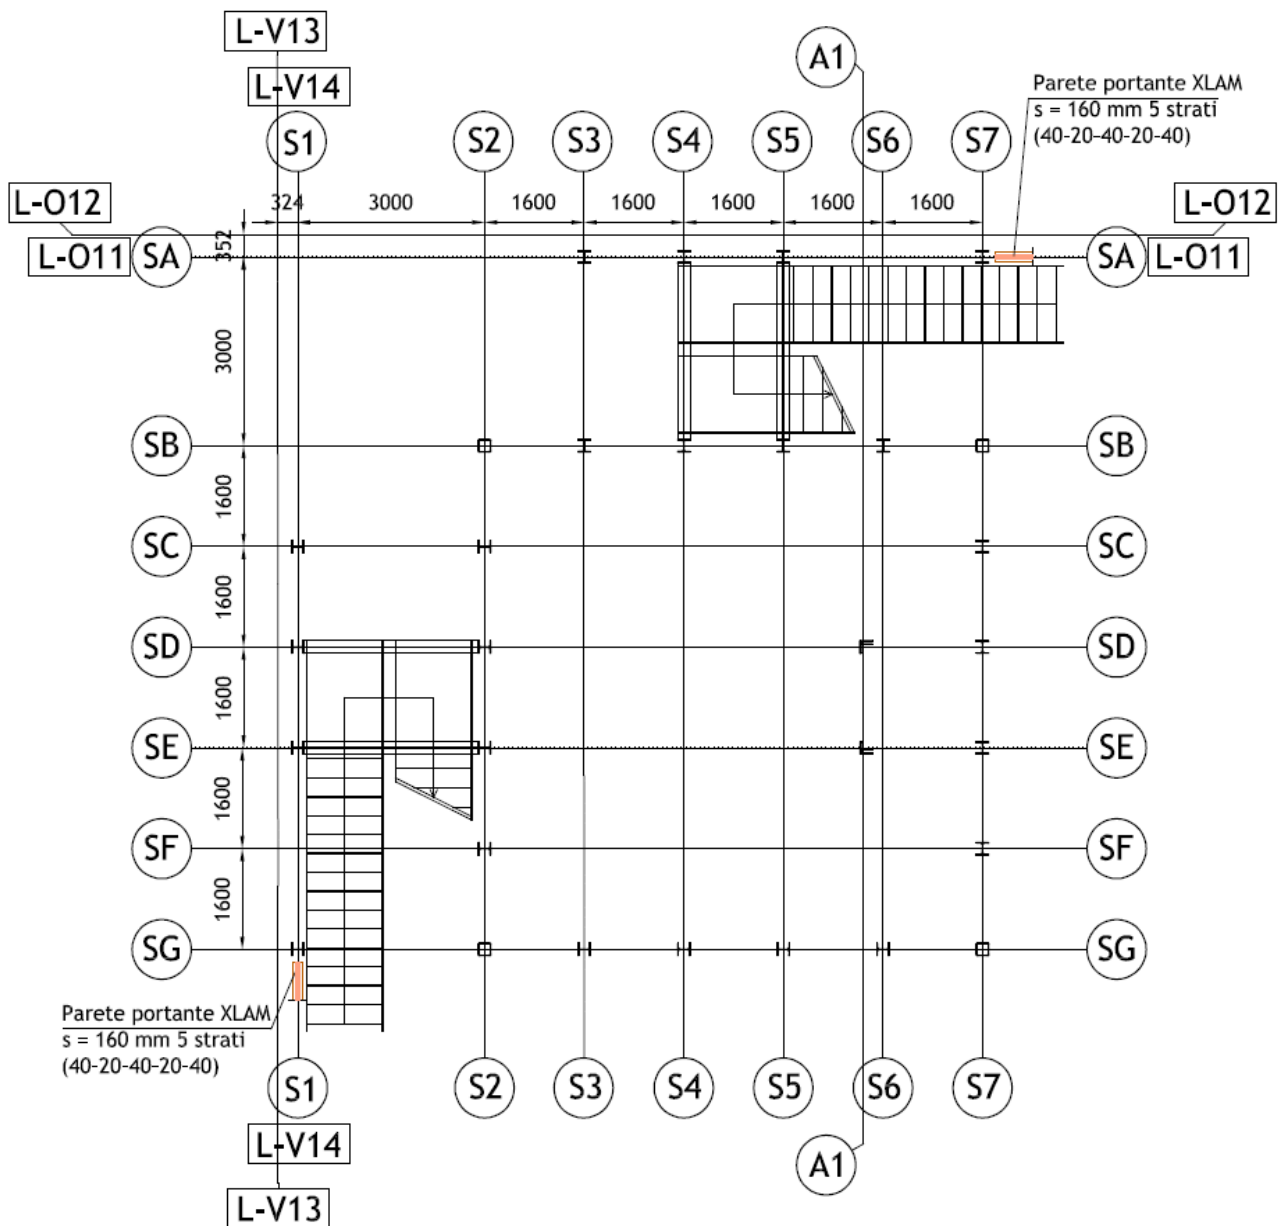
US 02-S planimetria piano terra zona triplo volume e vani scale
